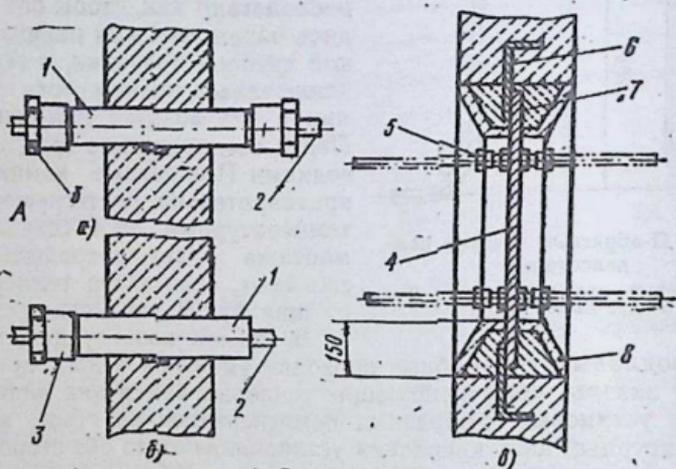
Уплотненные проходы одиночной трубы через стены помещений классов П-1 и В-1 (а) и В-1а, В-1б и В-1в (б) и групповых трубных проводок через внутренние стены помещений с взрывоопасными смесями (в):
